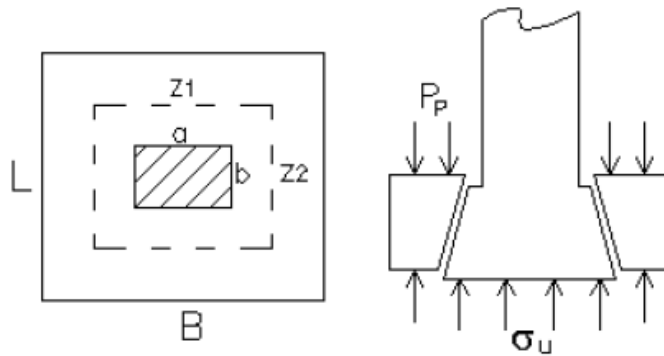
Punzonamiento ocurrido en la Zapata
